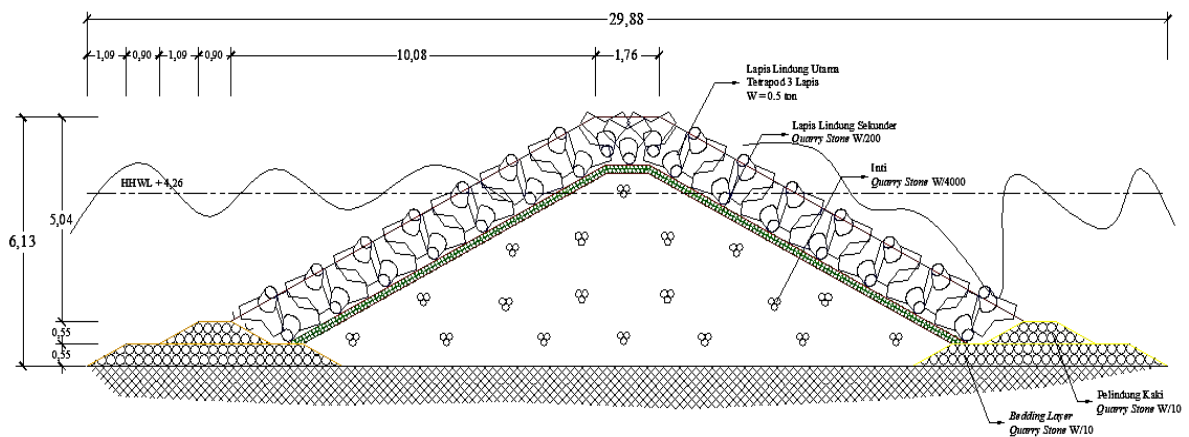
Layout Bangunan Pantai *Detached Breakwater
